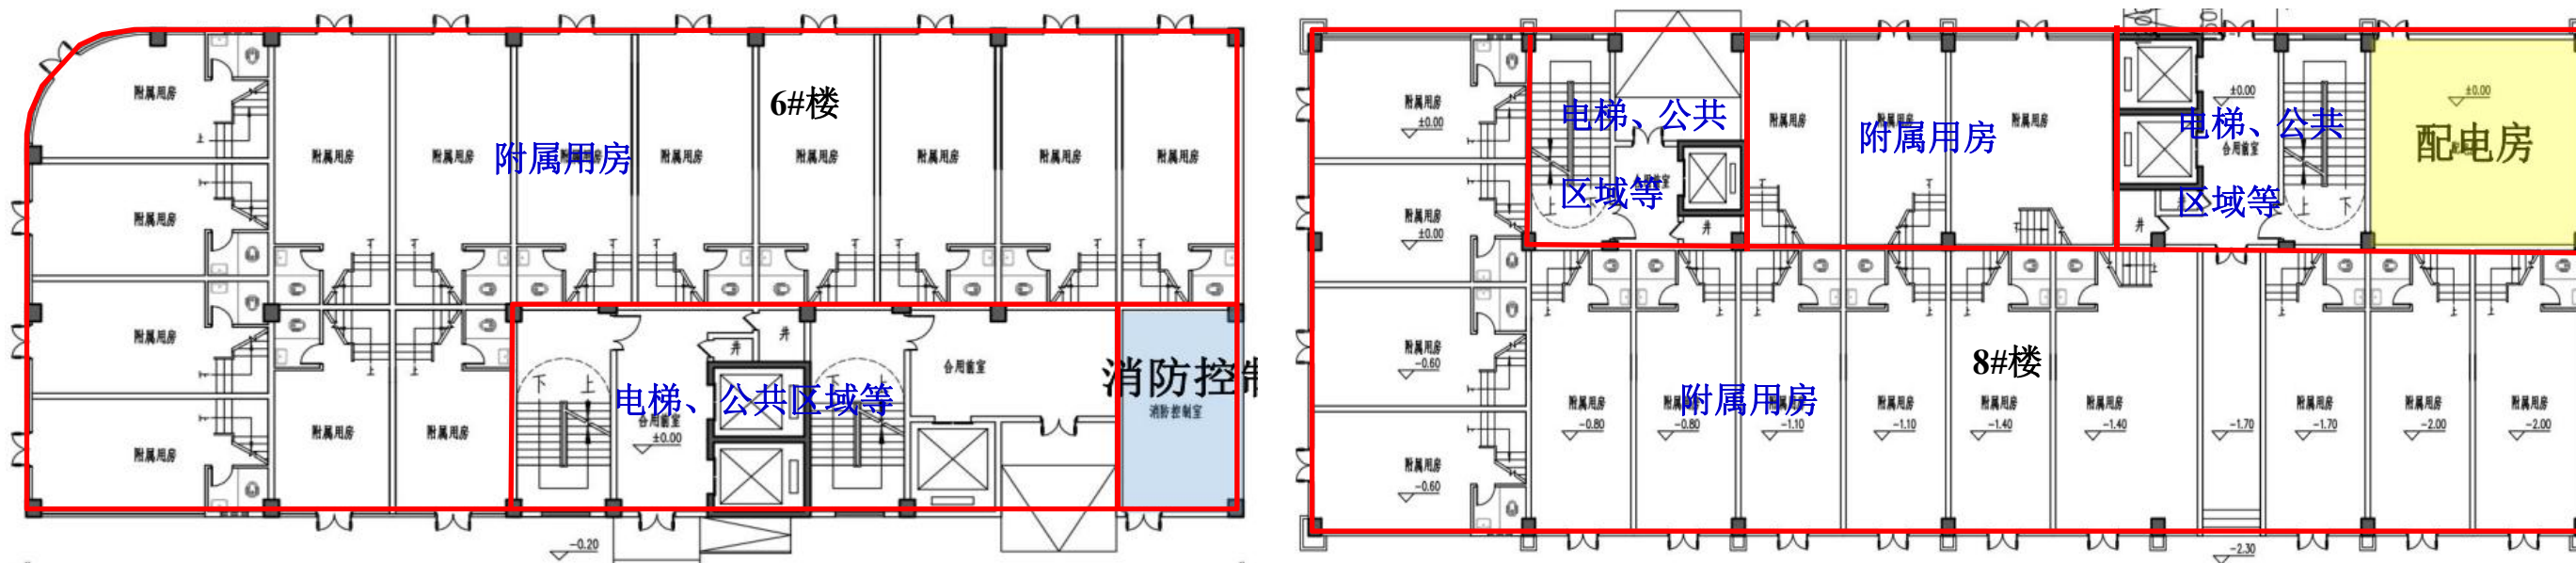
6#附属用房、8#自理楼首层平面图
